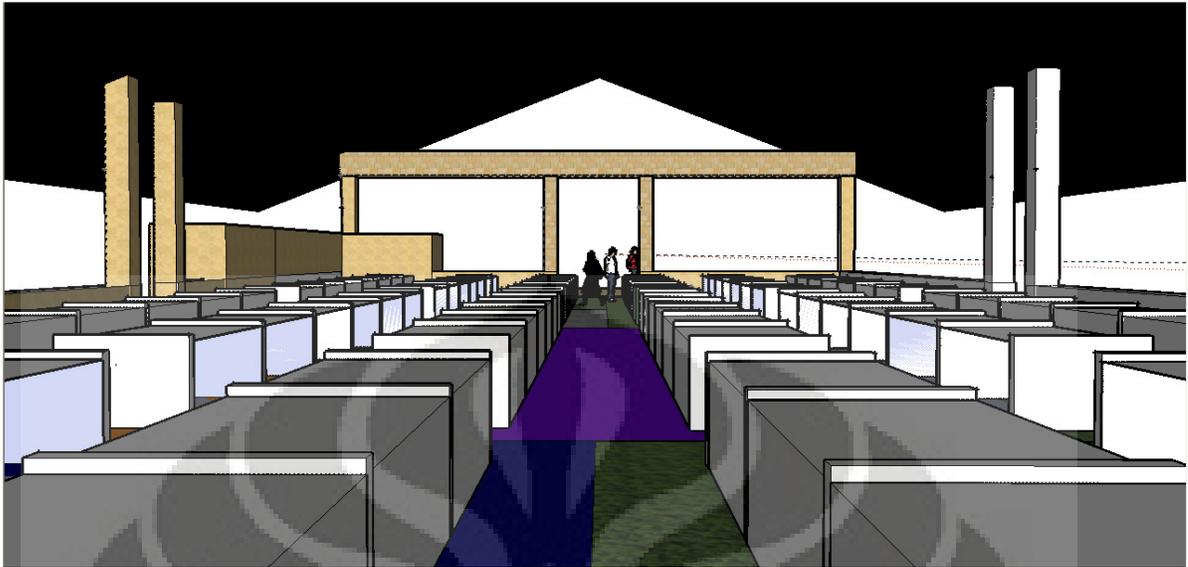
Tampak Dalam Bagian Depan Bangunan Pasar
